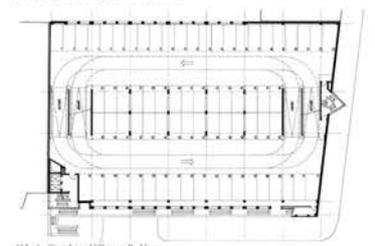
Grundriss, Hillmann Parkhaus
